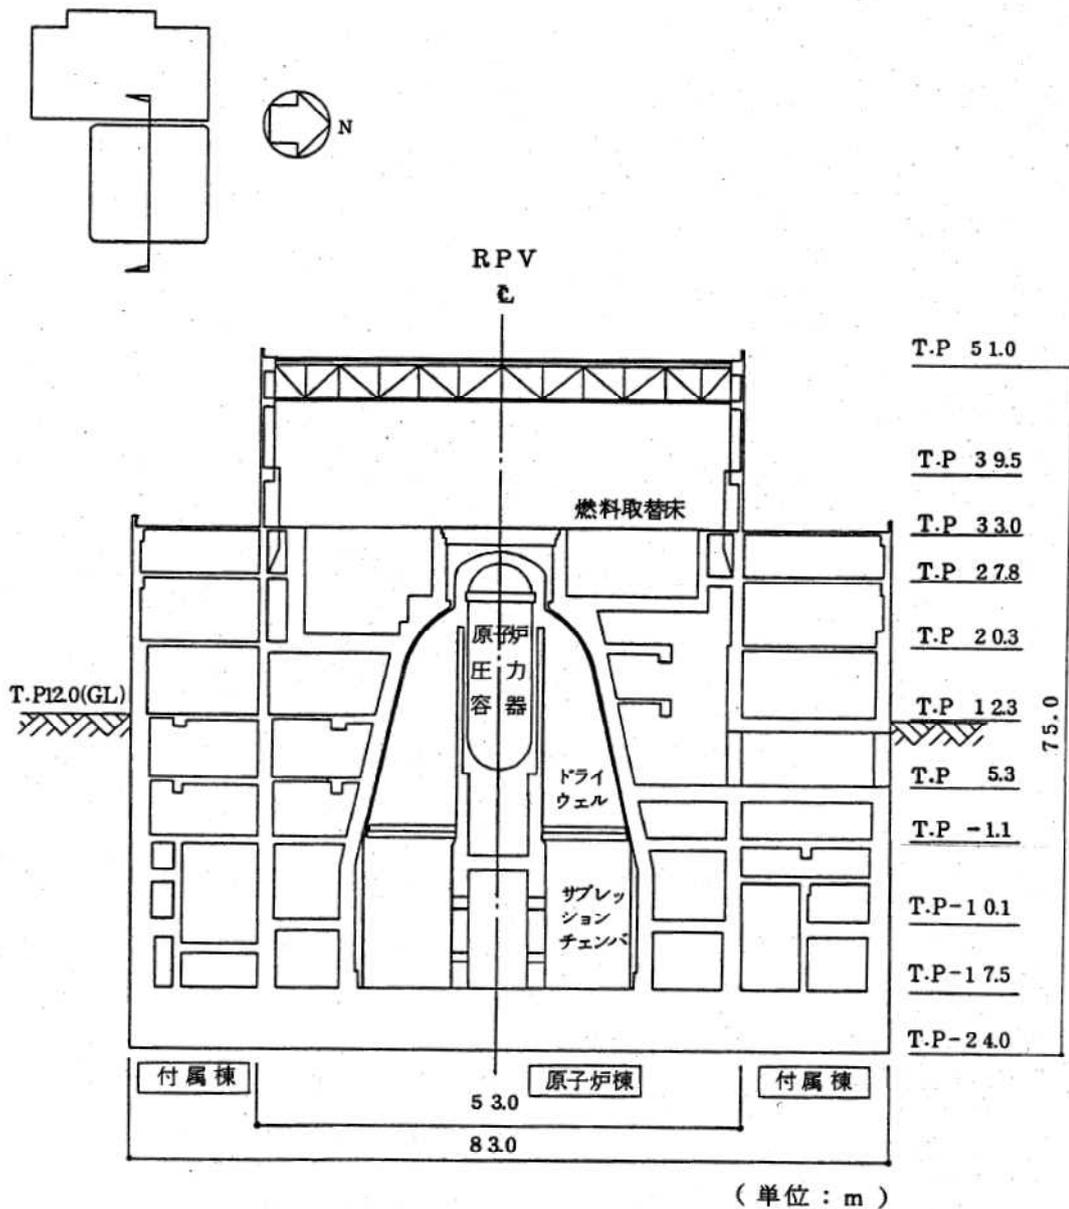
5号炉原子炉建屋断面図 (EW 方向)
